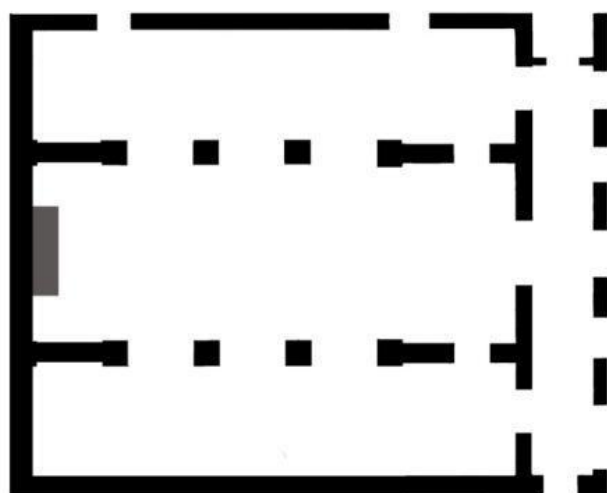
Reconstituição conjectural da planta da Capela Real edificada no período da Restauração, com a planta que teria em finais do reinado de D. Pedro II
